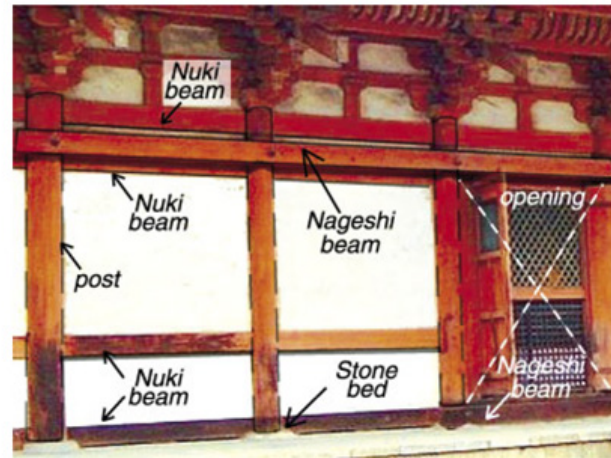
Fotografías sobre el sistema constructivo de poste y viga, elementos verticales se señalan como postes y las vigas aparecen nombradas como dos tipos distintos: Nuki y Nageshi. Fuente: Shiratori (2008).
